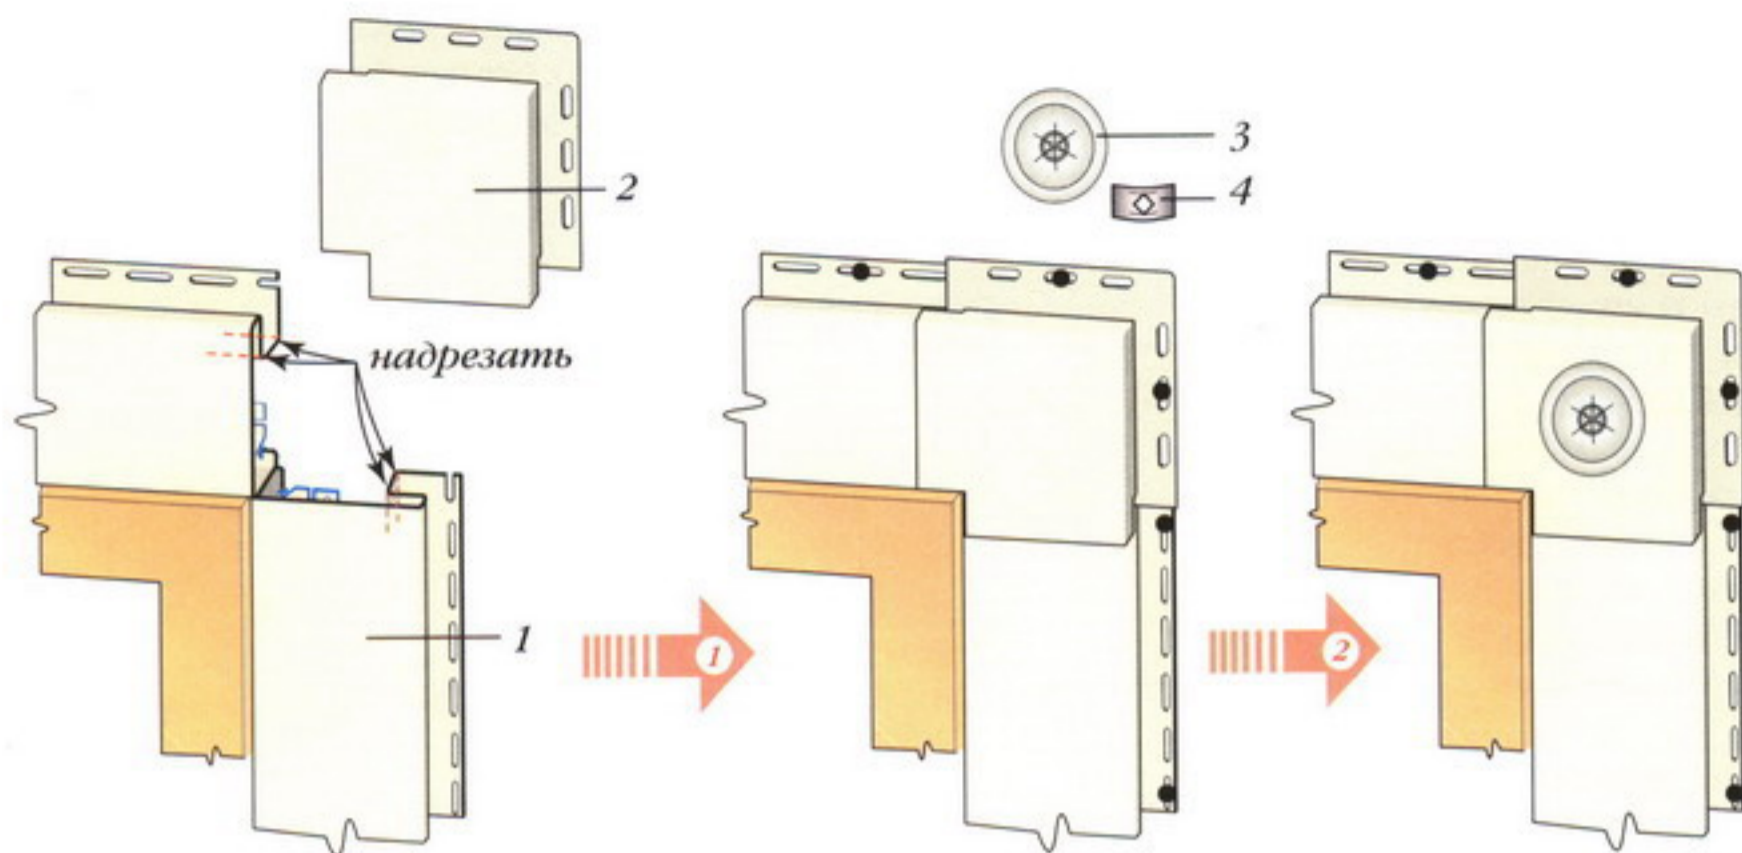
Установка угловых декоративных элементов: 1 — виниловая доска; 2 — угловой декоративный элемент; 3 — виниловая розетка; 4 — клипса
